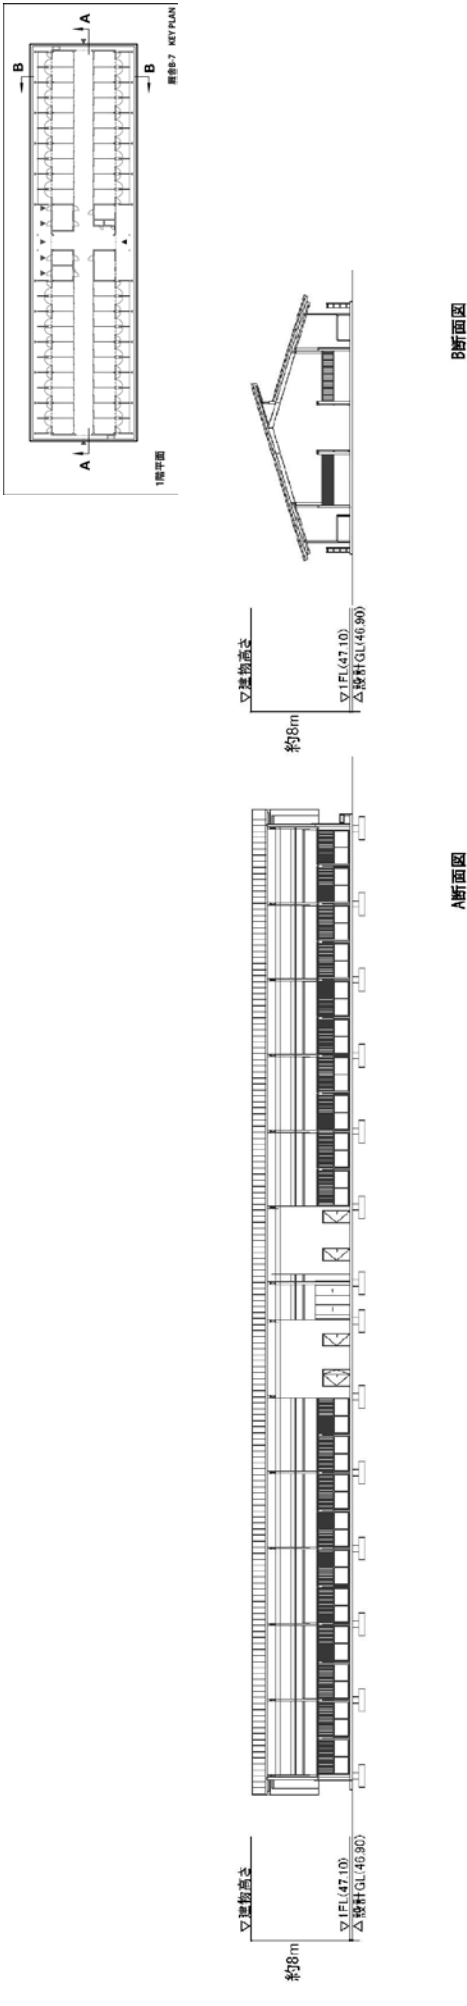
(6) 断面図 (厩舎 (B-1~B-7))
